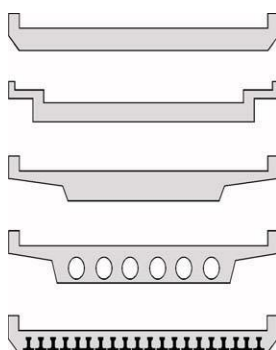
Sección transversal de puente tipo 02, losa simplemente apoyada
